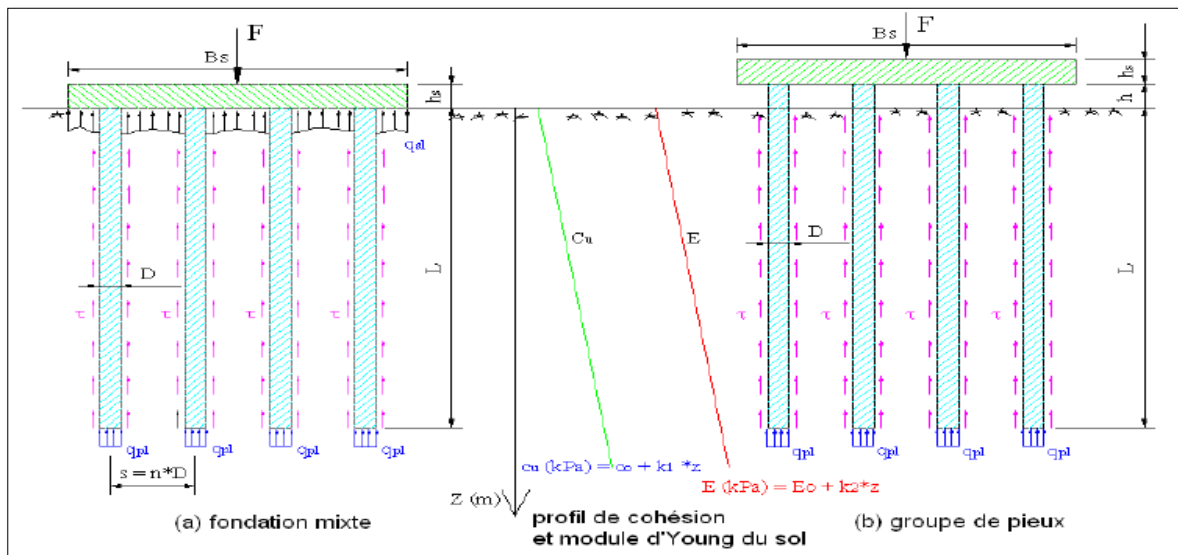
Comparaison entre le comportement de fondation mixte et le groupe de pieux.
